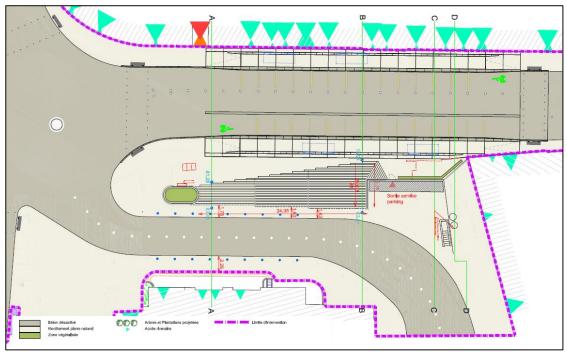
La création d'un escalier et d'un belvédère en modifiant la structure du parking.
